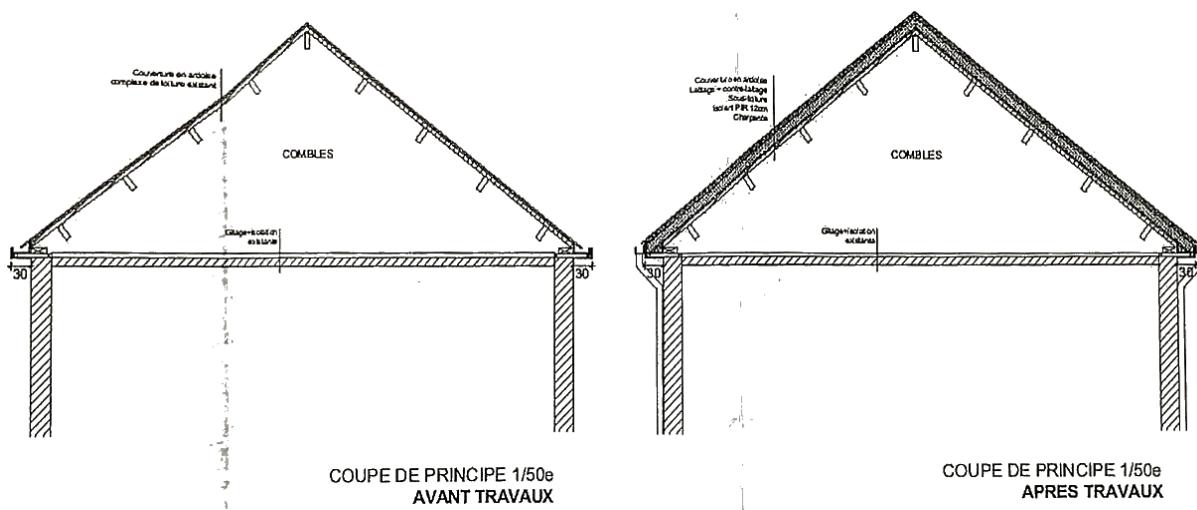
Coupe de principe du détail de toiture. architecte ACDC architectes, ca.2020. source : archive de la CRMSF (annexe 6)
